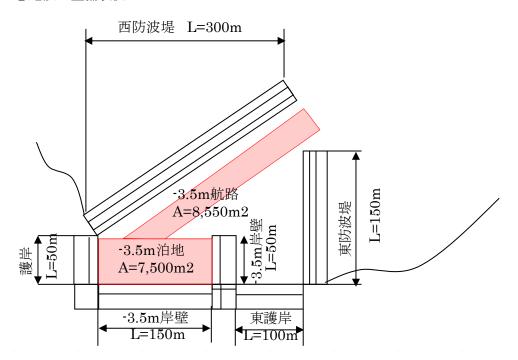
3.5m 航路 · -3.5m 泊地平面図
